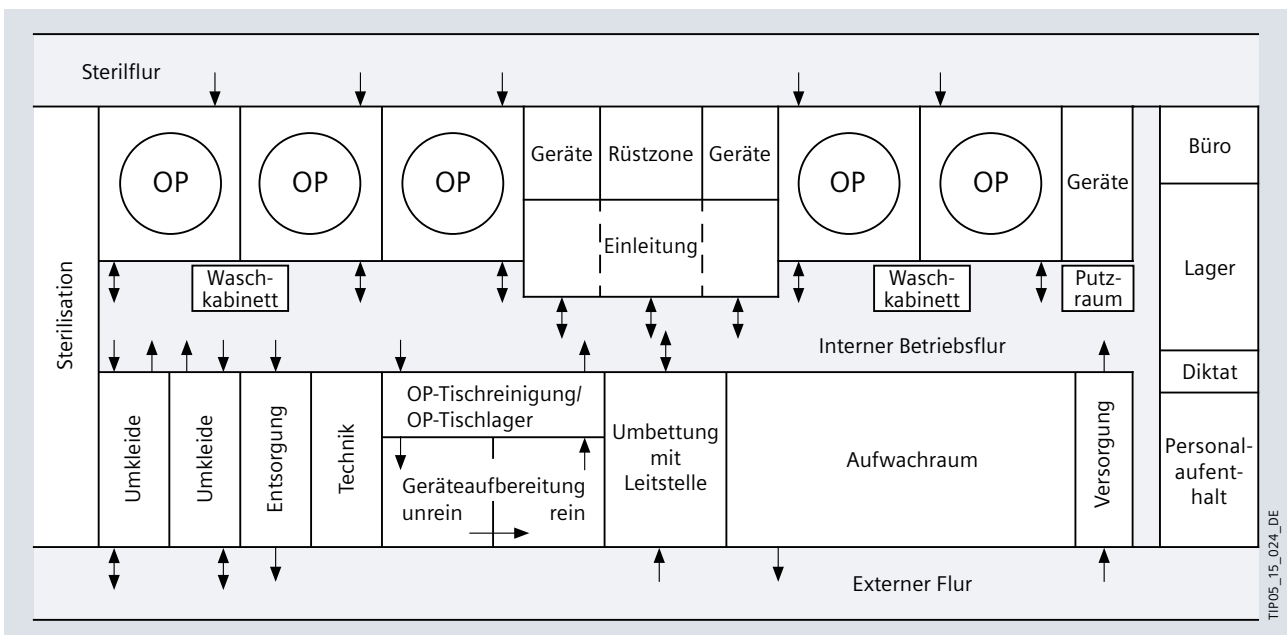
/4: Grundriss einer OP-Abteilung nach [48]
